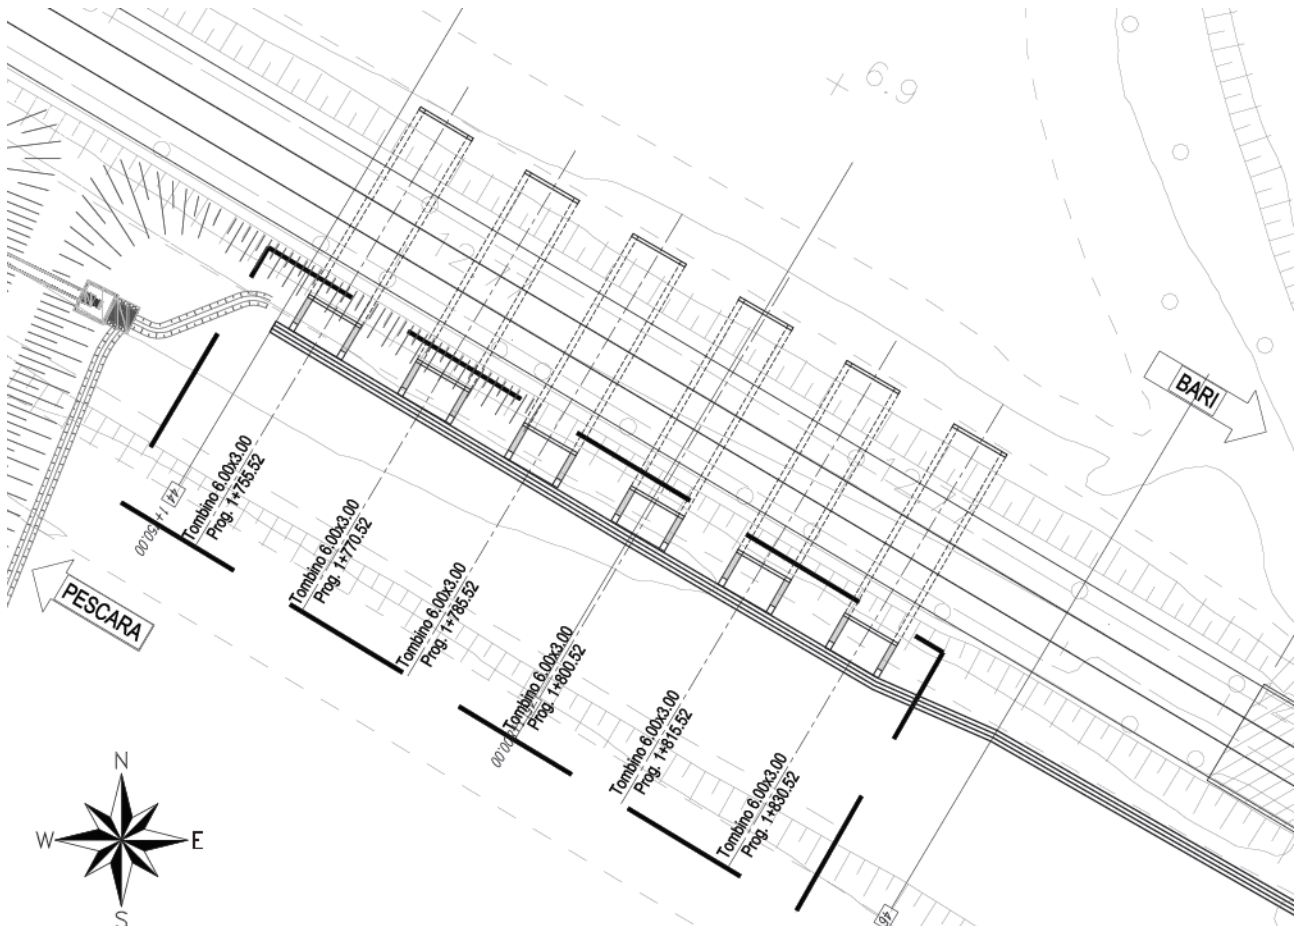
Tombini di trasparenza Sponda sx Fiume Fortore – Vista Planimetrica
